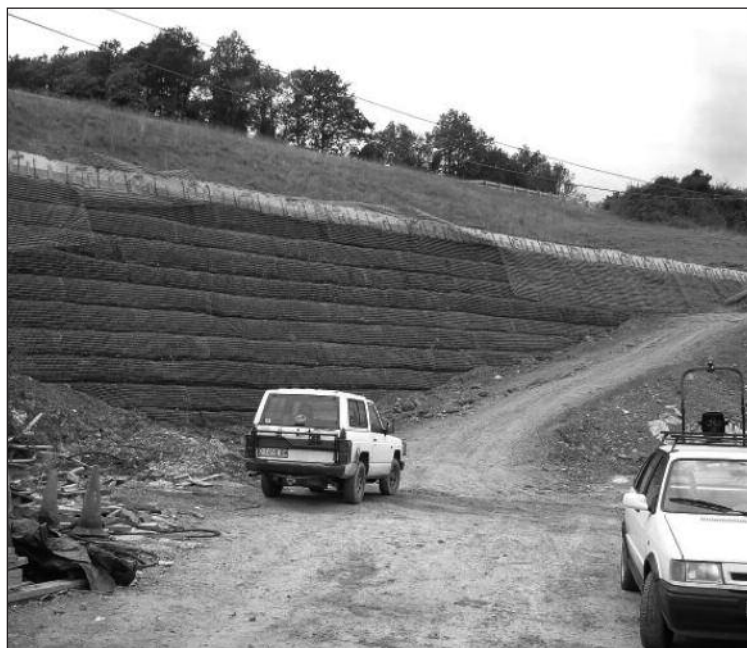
Muro de terra reforzada recentemente construído na Autovía A-68 en Llera (Asturias) (foto: A. Sáiz)
